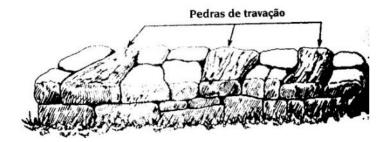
Ilustração de um muro de onde se destacam as pedras de travação.
